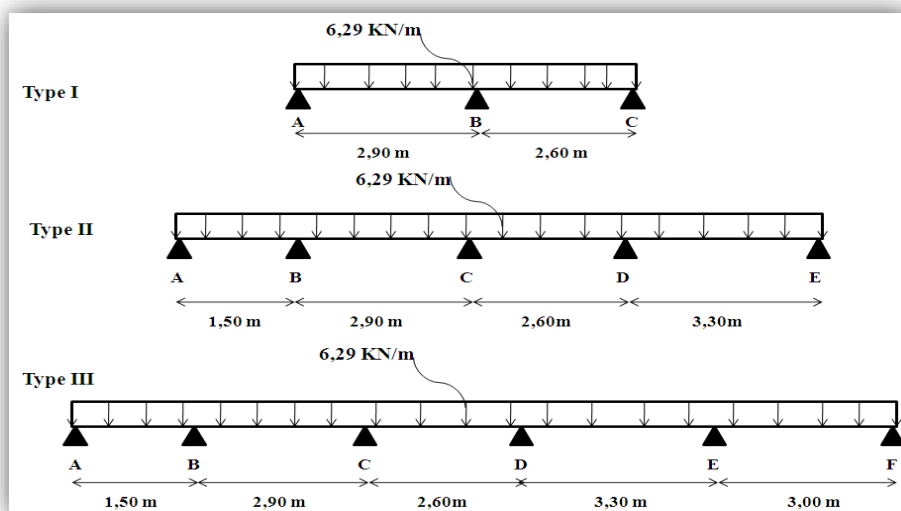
Types des poutrelles de notre structure à L'ELU (RDC et Plancher étage courants).
